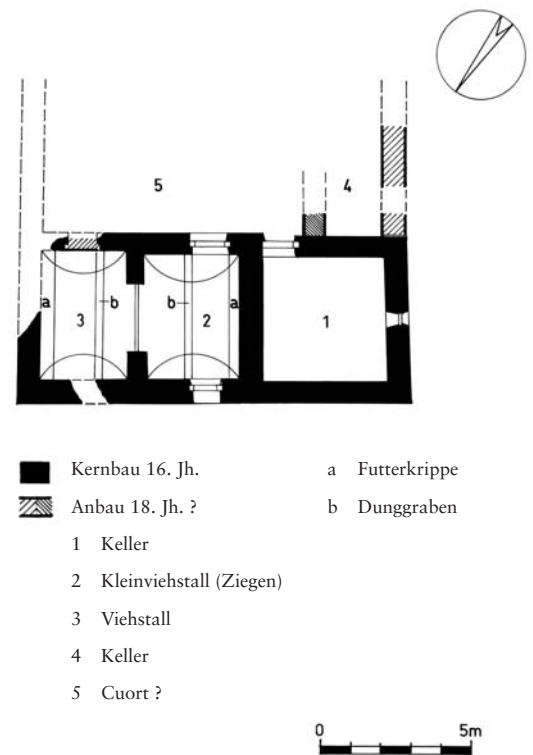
Silvaplana/ Surlej 1997, «Bellavista»; Grundriss, Phasenplan Mst. 1:250.
